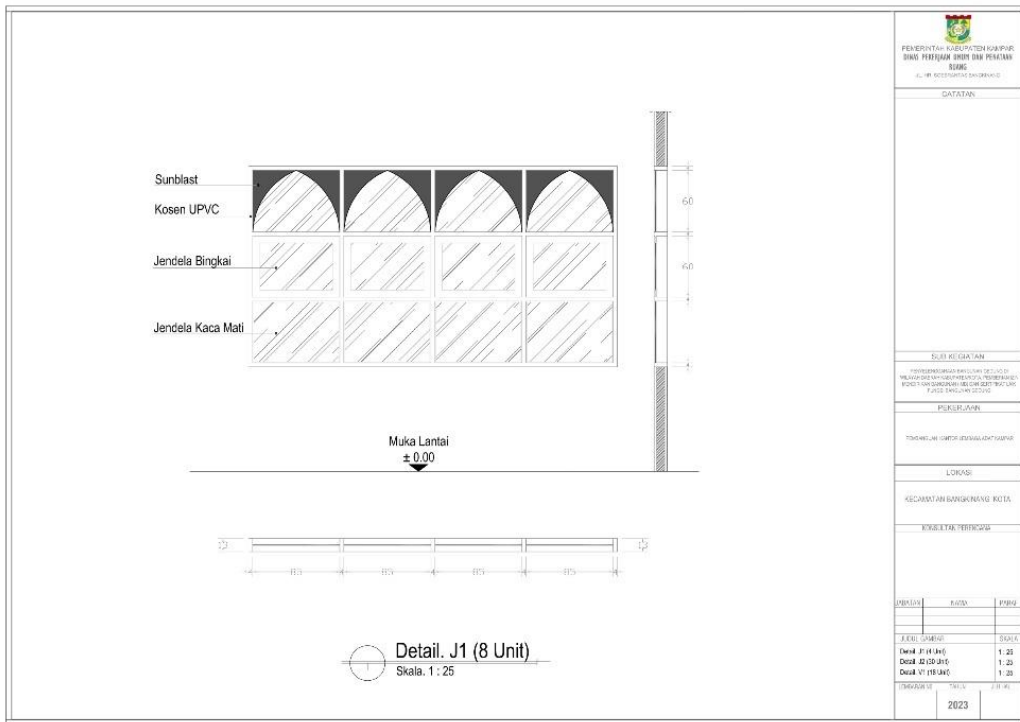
Detail Kusen, Pintu, Dan Jendela
